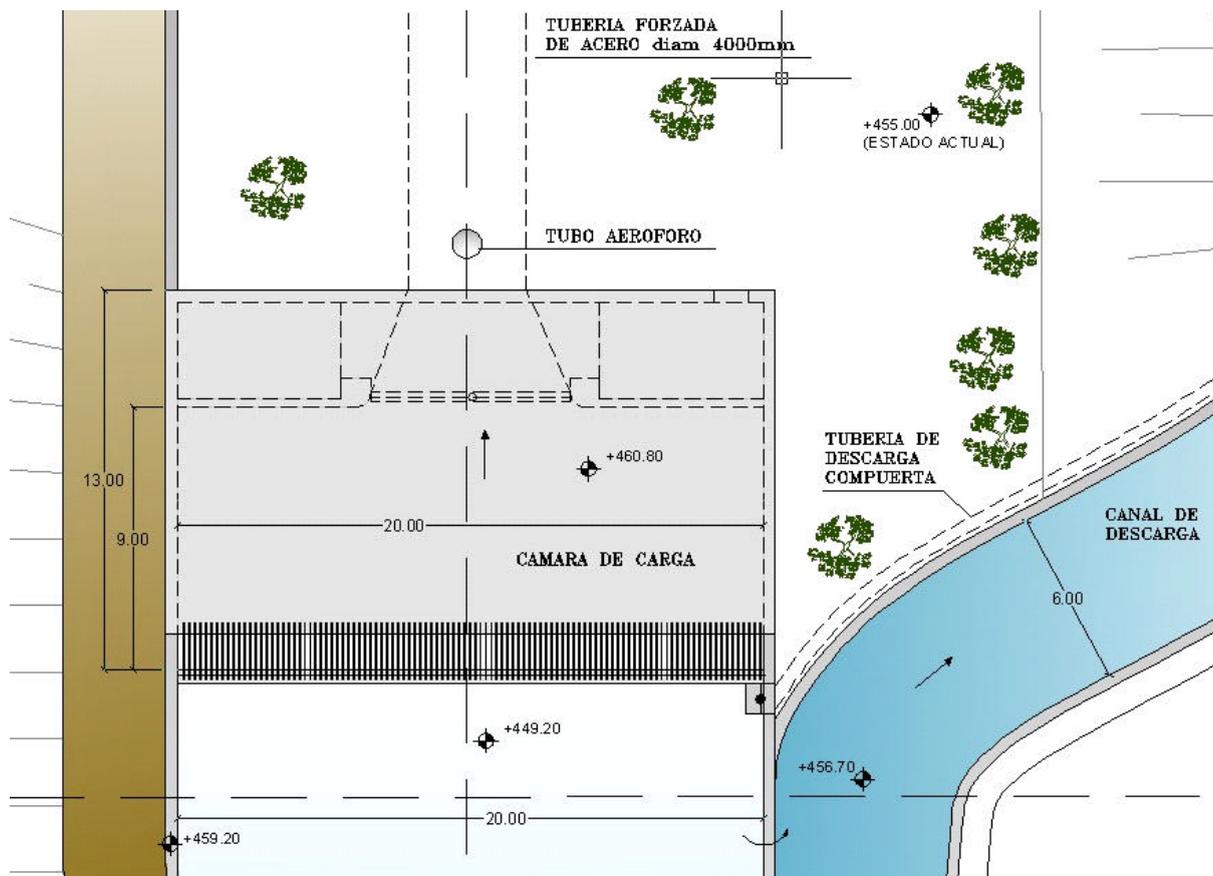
Vista en Planta de la Cámara de Carga
